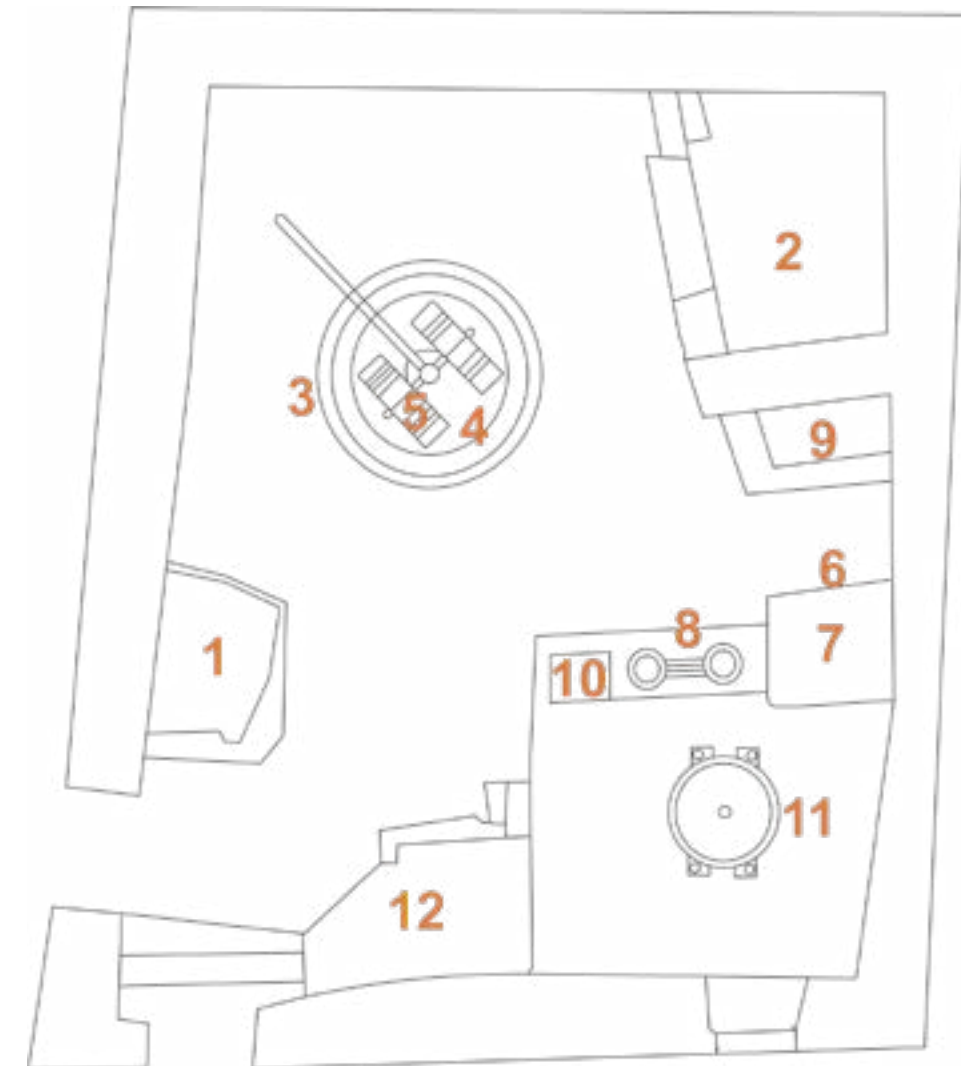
Planta do lagar com a localização das estruturas que o constituem
